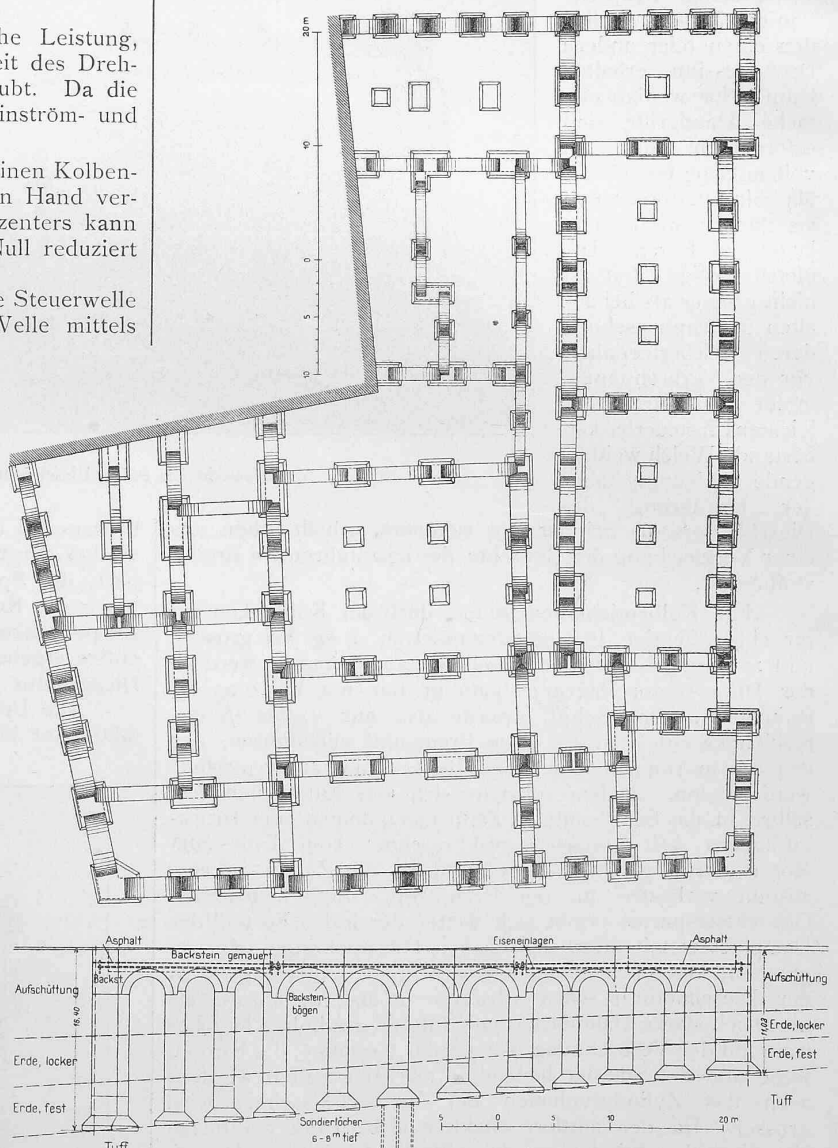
und 19. Grundriss und Aufriss der Fundamente. — Masstab 1 : 600.
